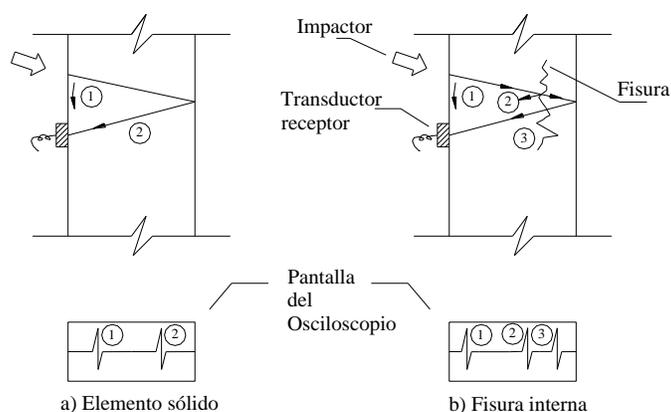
Ensayo Ultrasonico, técnica del Eco-Pulso
